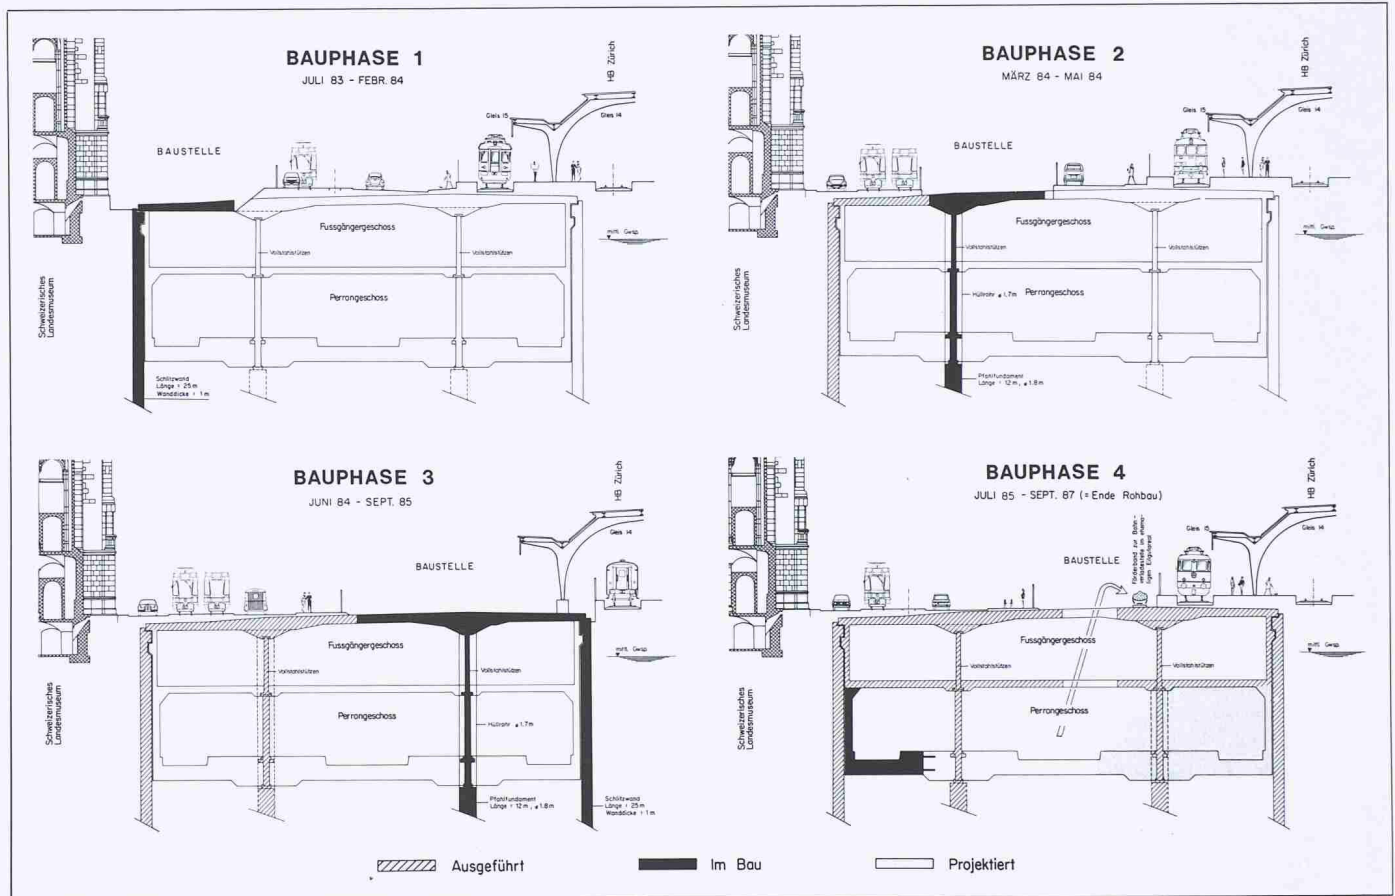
Querschnitt Museumstrasse mit Bauvorgang Bauphasen 1 bis 4
